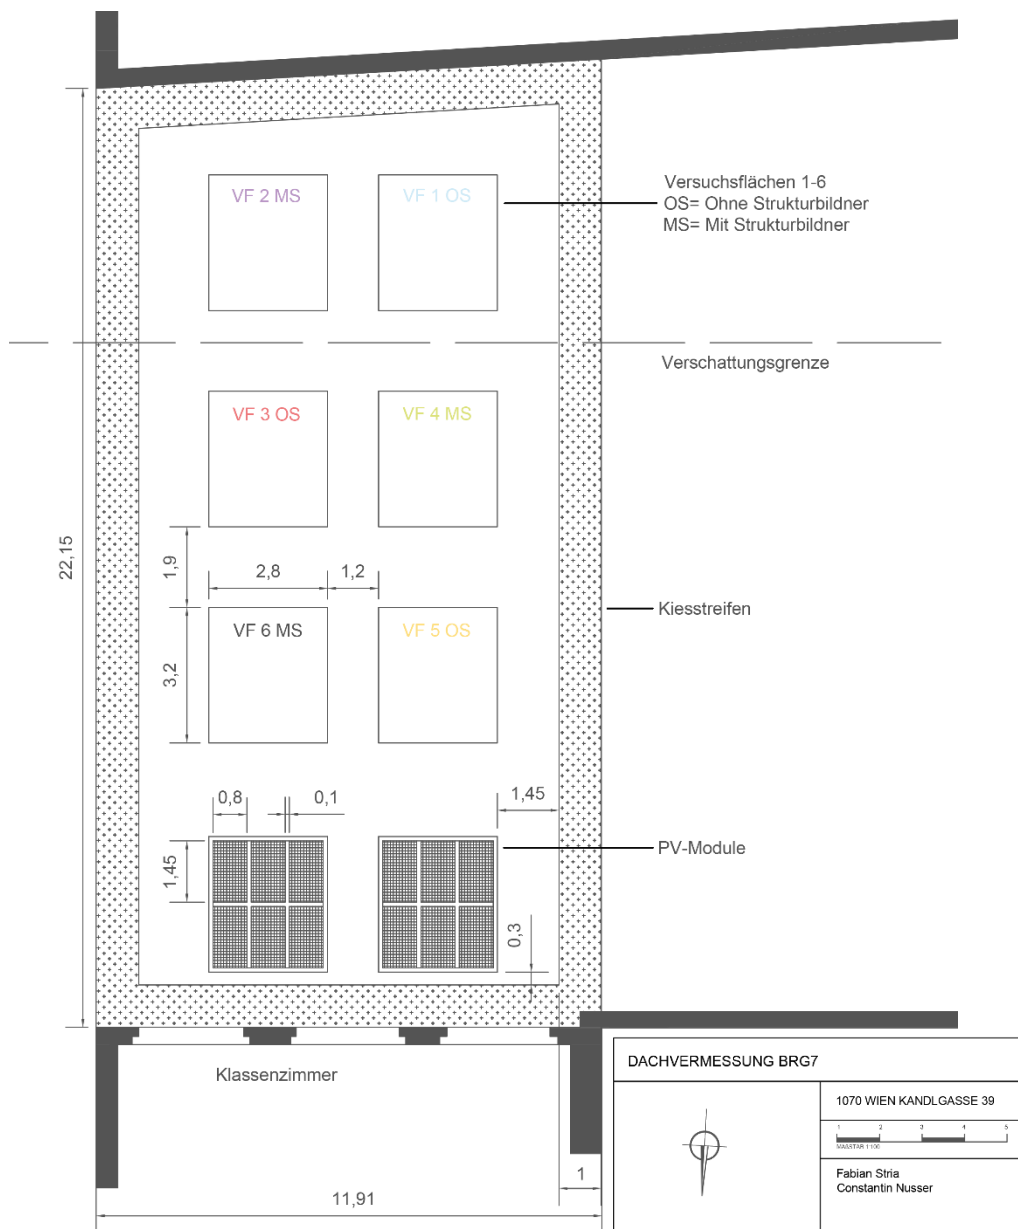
Grundriss, Dach des GRG7 mit Einteilung der Versuchsflächen und Photovoltaikanlagen
